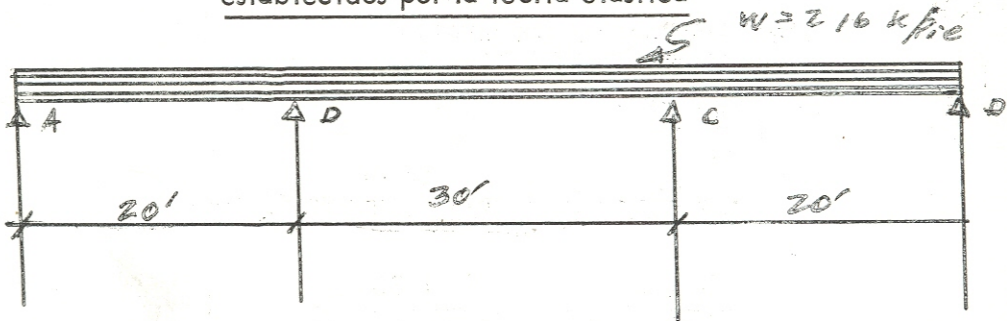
Viga de Tres Tramos, Continua, de Sección Constante.
